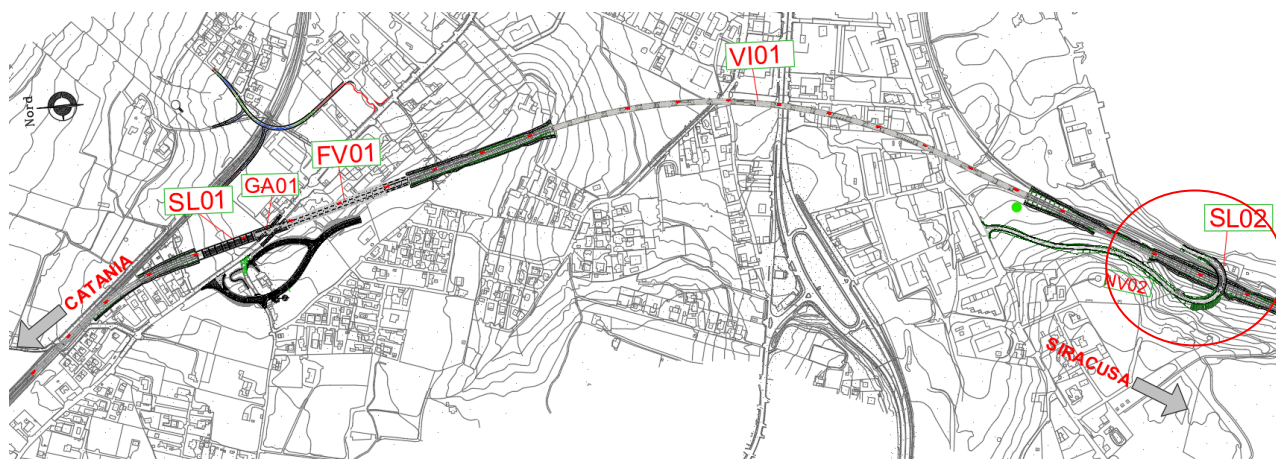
Bypass di Augusta –ubicazione in pianta del sottovia SL02
